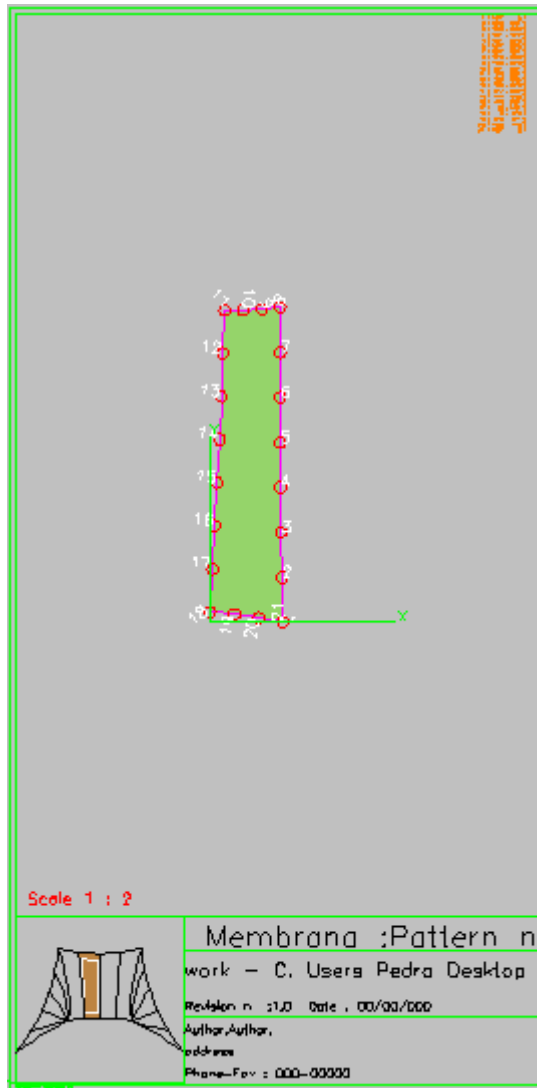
Exemplo de desenho de pormenor de um padrão de corte
